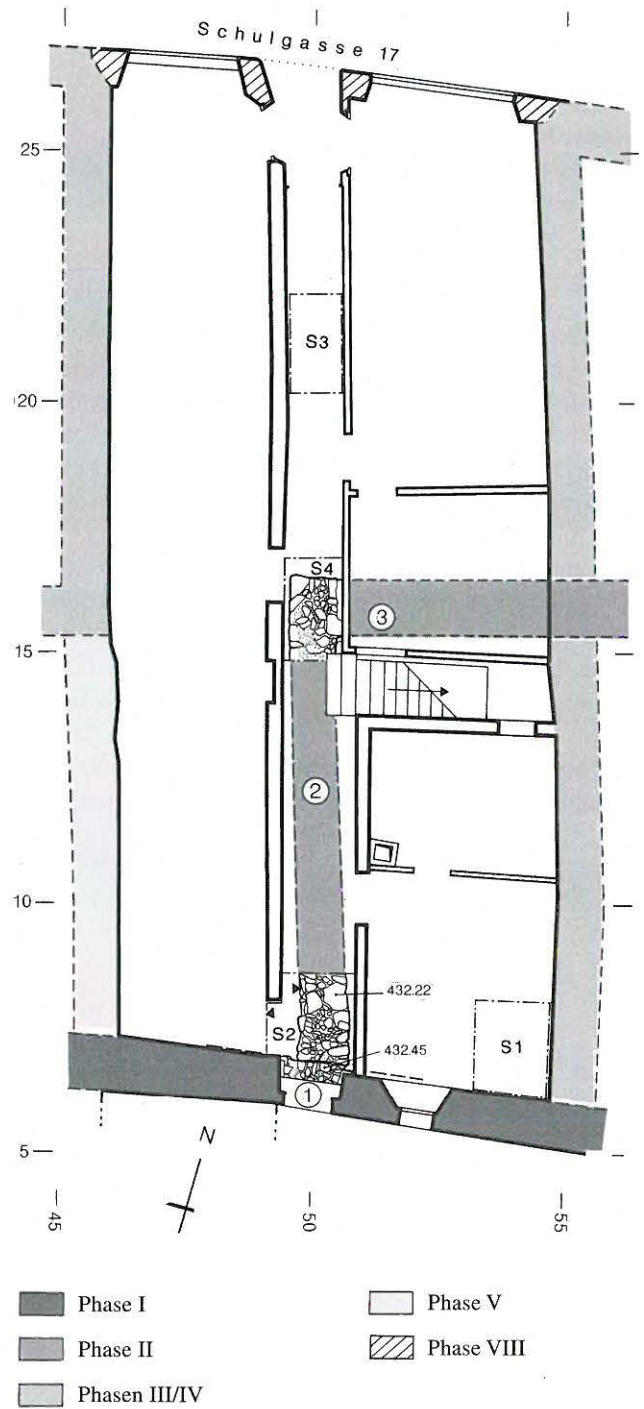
Nidau, Schulgasse 17. Grundriss des Erdgeschosses mit Eintragung der Sondagen sowie Bauphasen. M. 1:150. Legende siehe Text.
